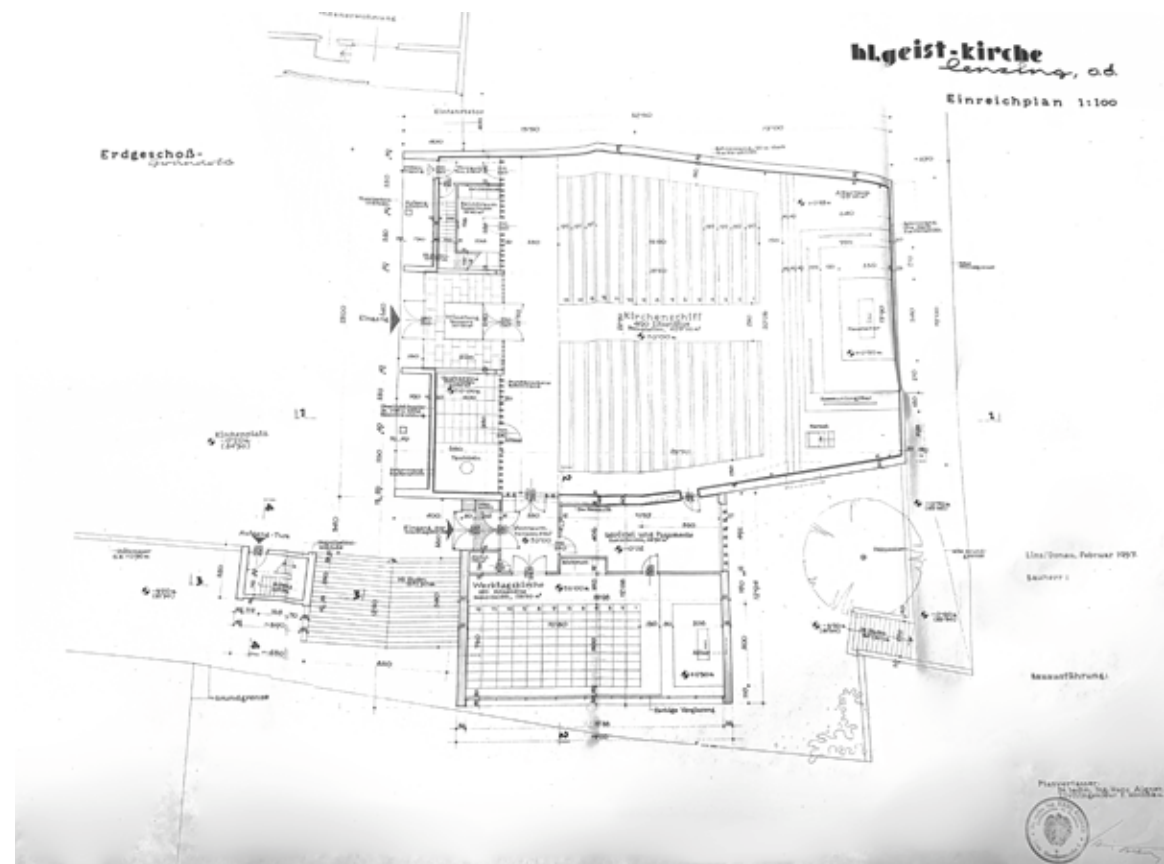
Einreichplanung 1957 Grundriss
